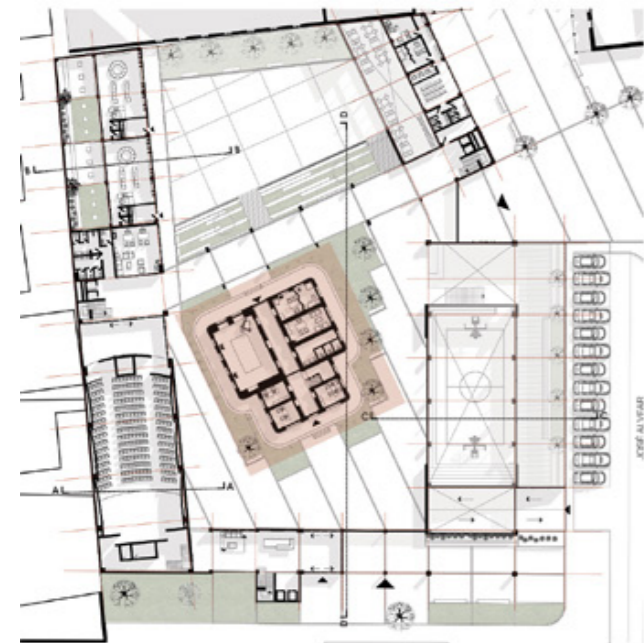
Esquema Planta baja | Fuente: Elaboración propia
